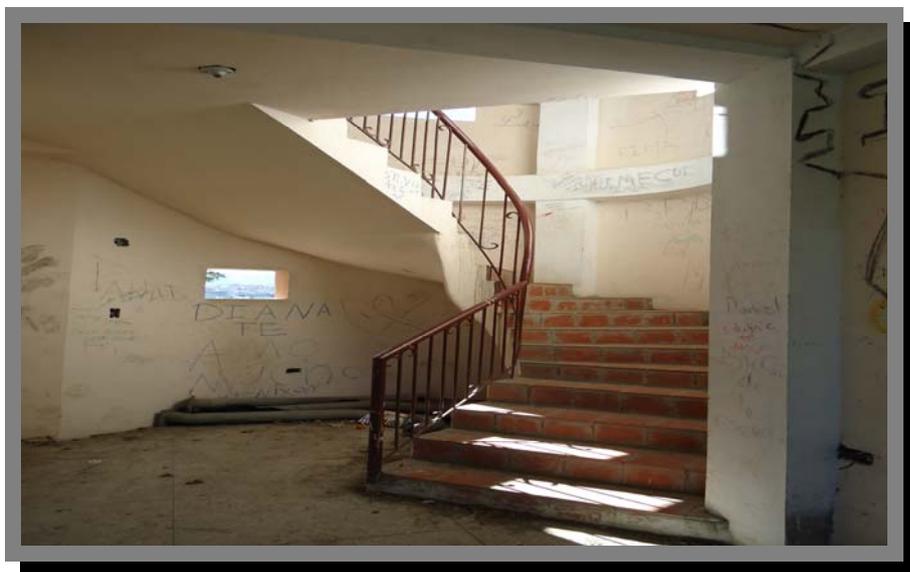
Instalaciones del proyecto teleférico deterioradas (María Reinoso 2010)
